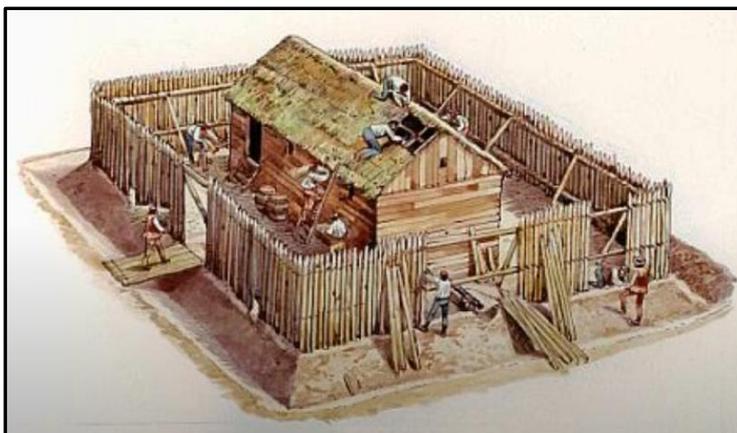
Fuerte Navidad levantado por Cristóbal Colón (Fuente: Pinterest)
